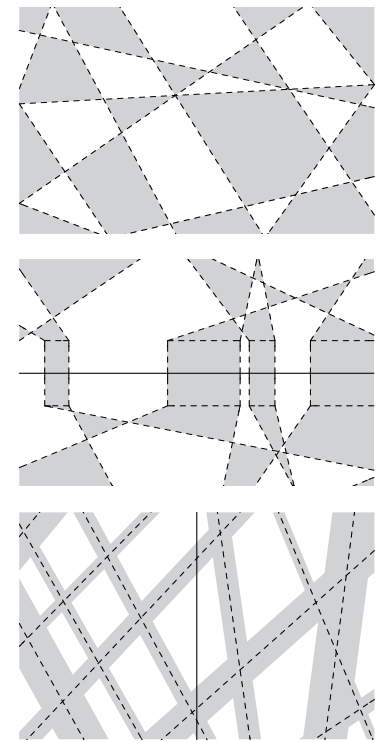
Zweifarbensatz, Konstruktion Dachanschluss, Konstruktion Eckausbildung bei ebenen- gleicher Ausführung der Kanten als Tragwerk
